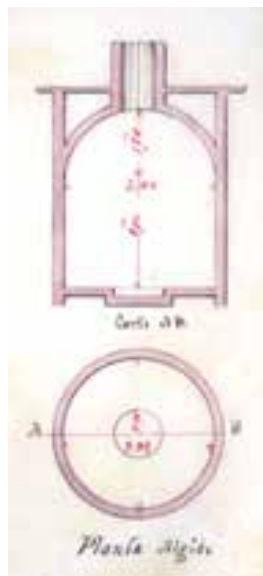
Plano de «Proyecto para edificar una casa [...] sito en la Calle Independencia [...] propiedad de Doña Celestina Corrales.» Junio 1888. Detalle: «Corte y Planta Aljibe» Se observa corte y planta circular de una cisterna de aljibe de una vivienda de fines del siglo XIX, la cual presenta pozo de decantación, cúpula y brocal. En En Archivo Histórico de Montevideo, IM.
